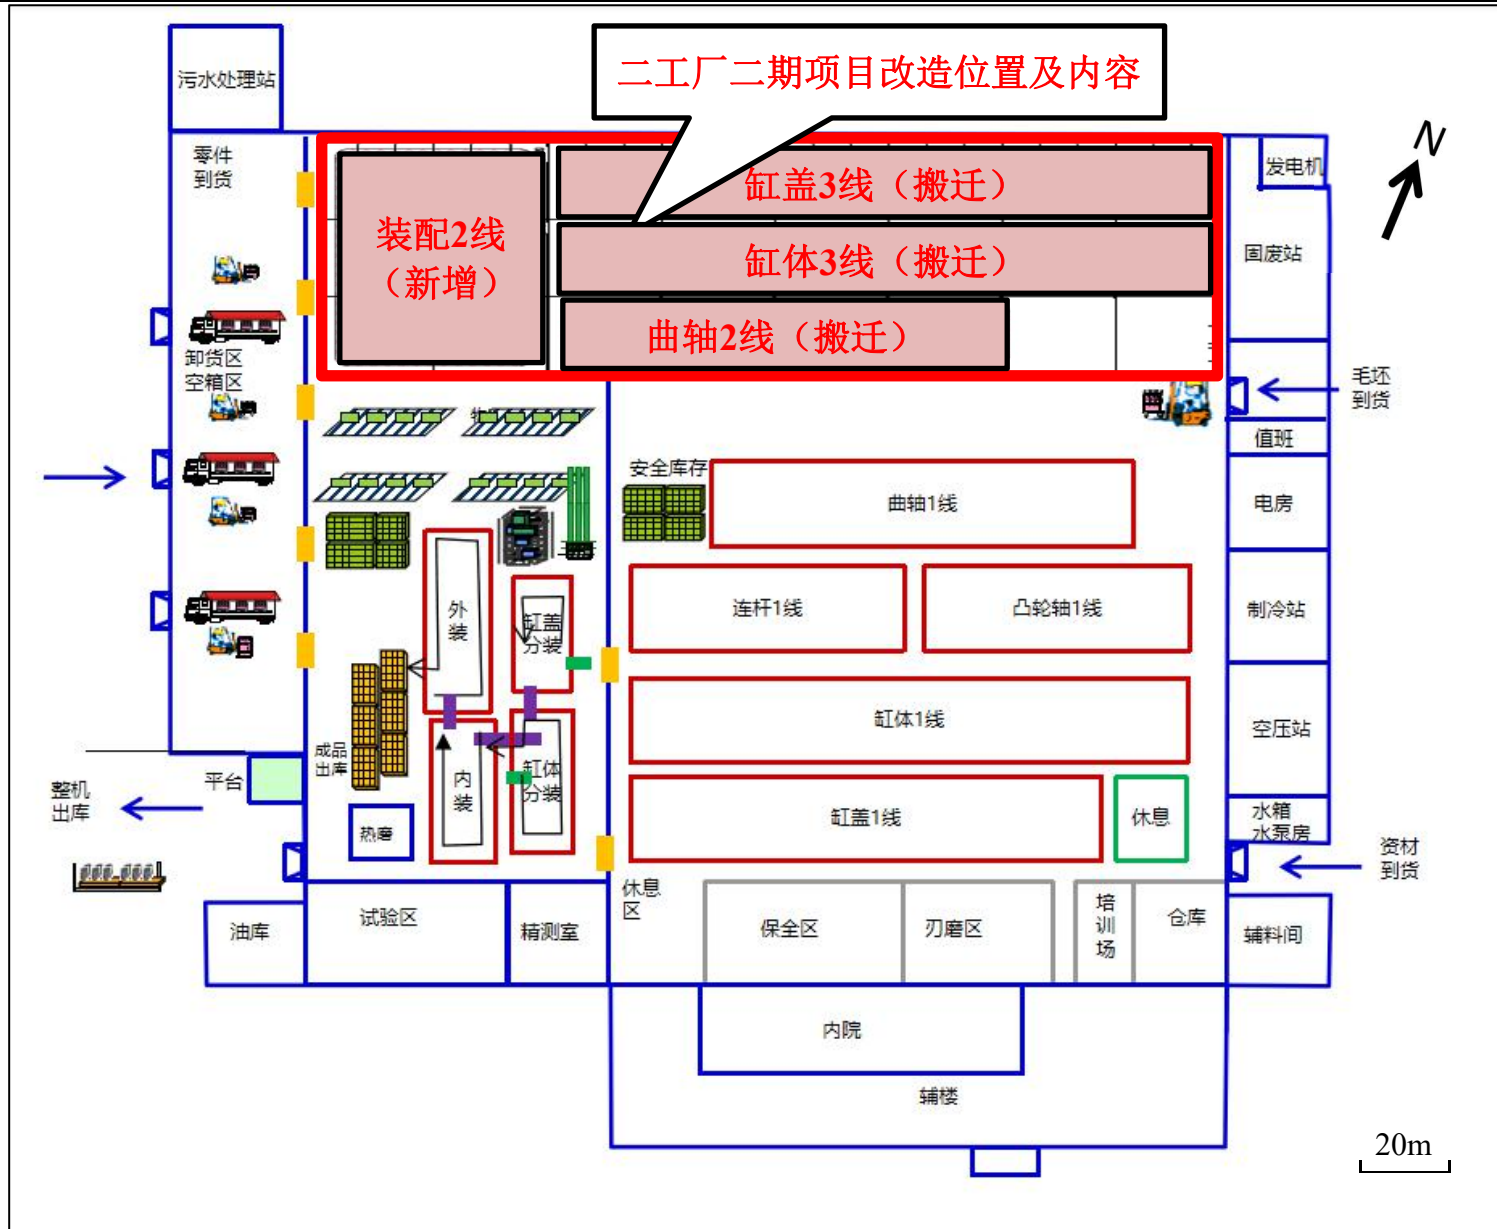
项目建设后二工厂发动机联合厂房平面布置图
